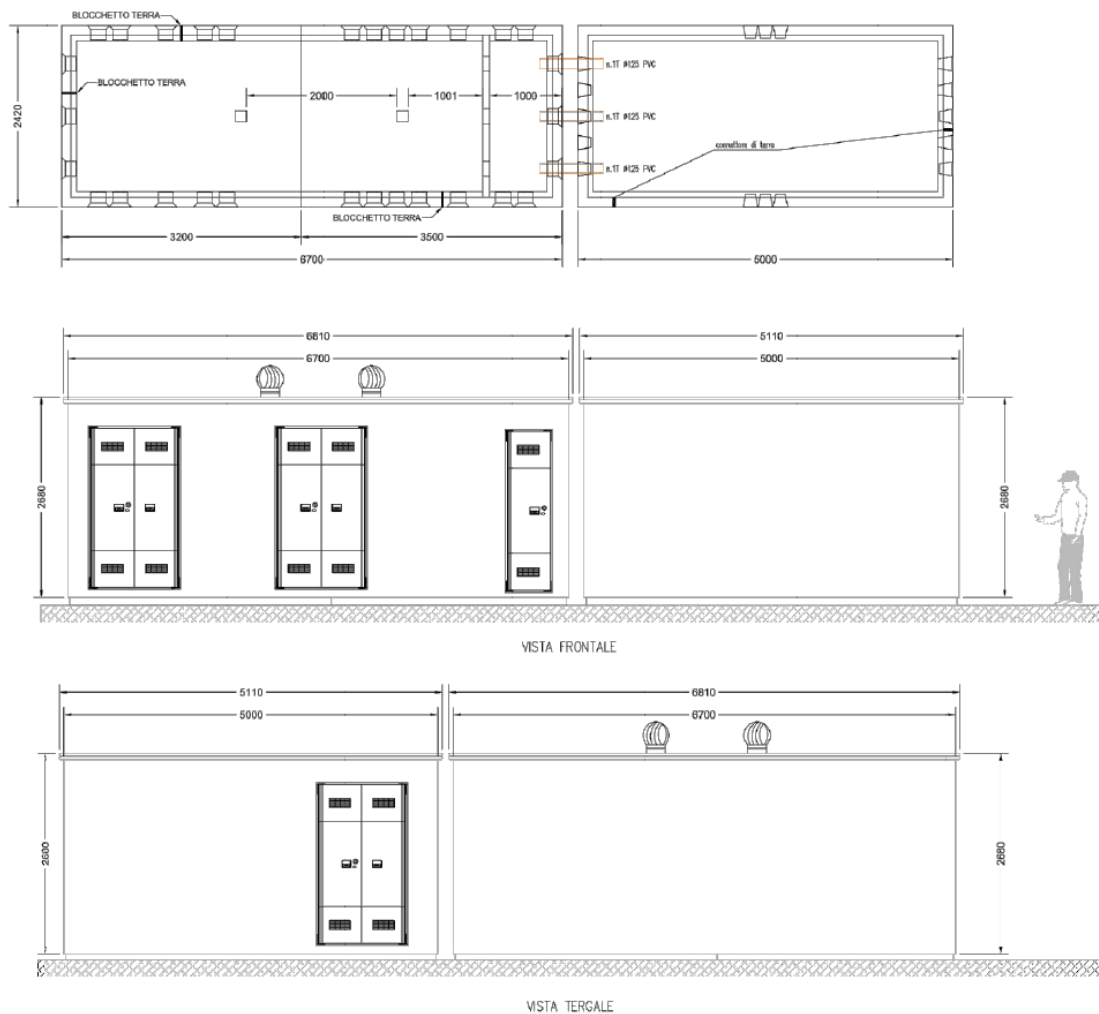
Planimetria e prospetto cabina di connessione e distribuzione elettrica
